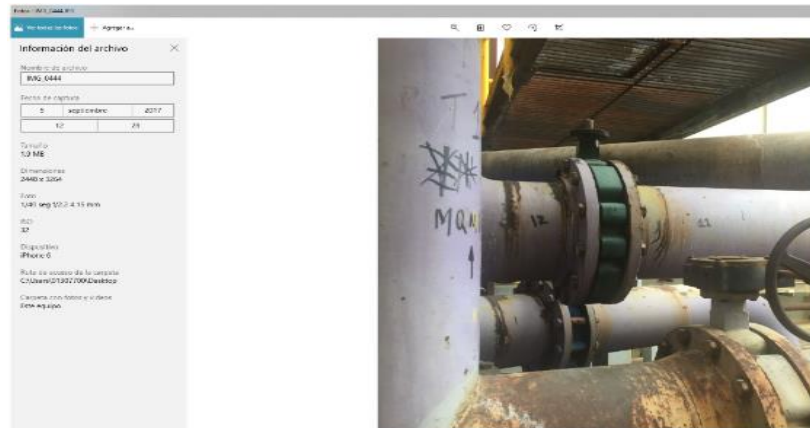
Válvula nueva ubicada en la tubería de ingreso a la Planta CIC Pampa Larga.
